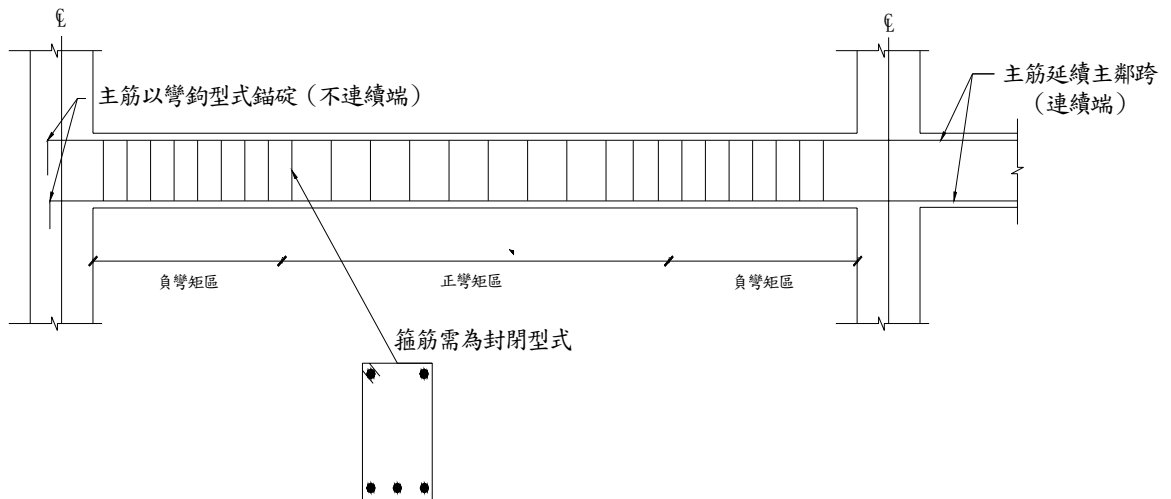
鋼筋混凝土樑鋼筋配置細節需求
